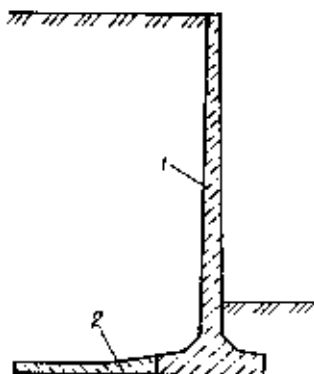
Конструкция подпорной стены с использованием универсальной стеновой панели
